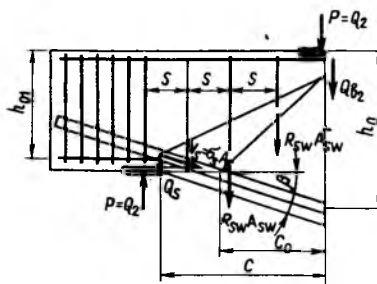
Схема расчетных усилий в наклонном сечении балок с наклонной растянутой гранью при горизонтальном положении балки
